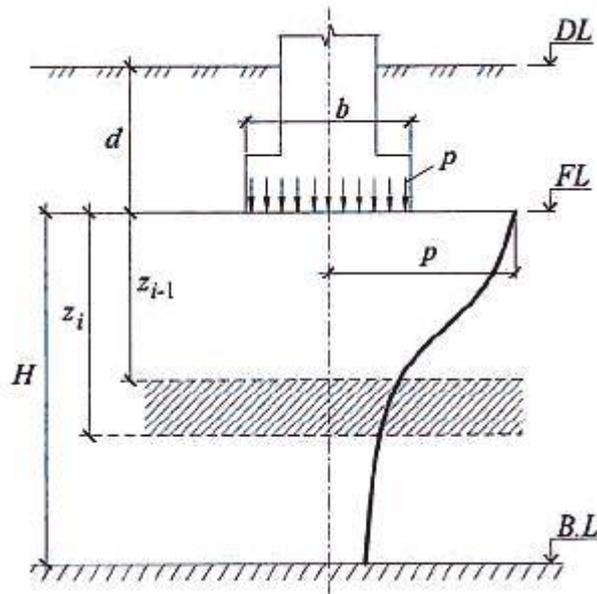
Схема к расчету осадок с использованием расчетной схемы основания в виде линейно деформируемого слоя
